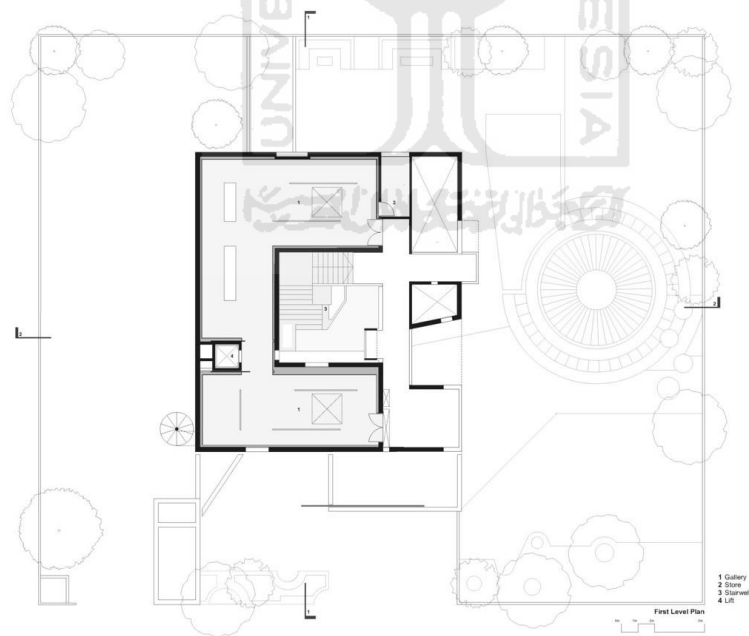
Detail Rancangan 079 Story Center For Arts
